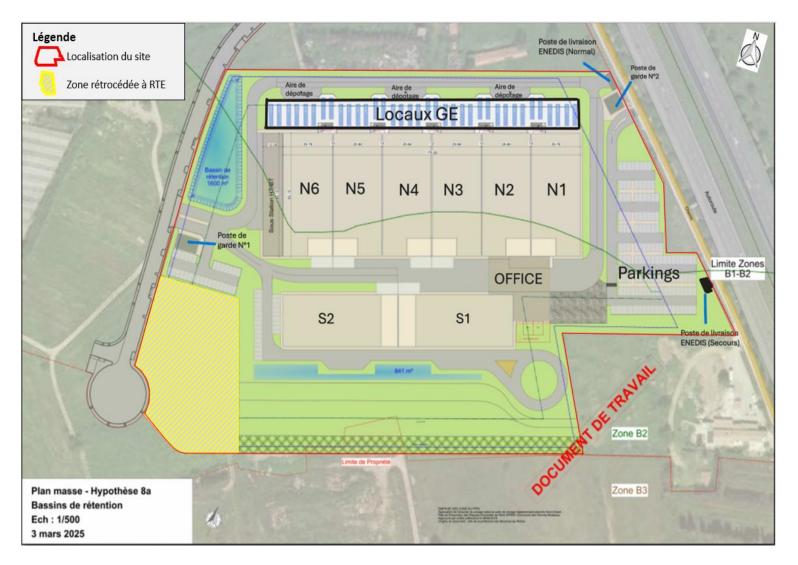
Plan de masse du projet de datacenter (Source : TELEHOUSE, le 19 mars 2025)
